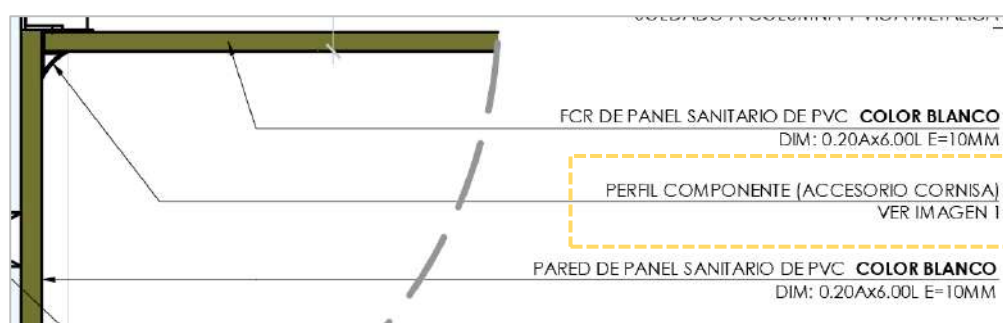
Imagen de detalle de ubicación de cornisa. Ver planos de detalles de arquitectura
